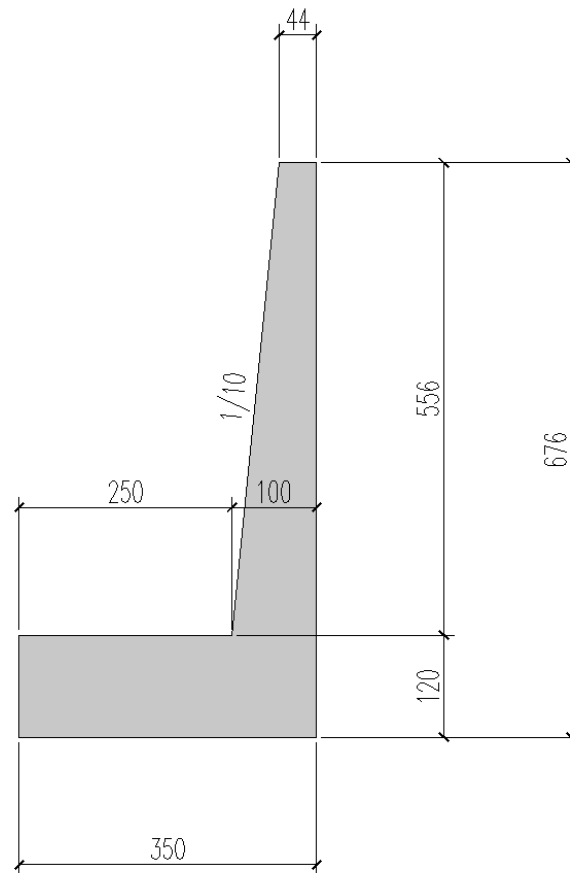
Carpenteria Sezione ad altezza maggiore del Muro M04
